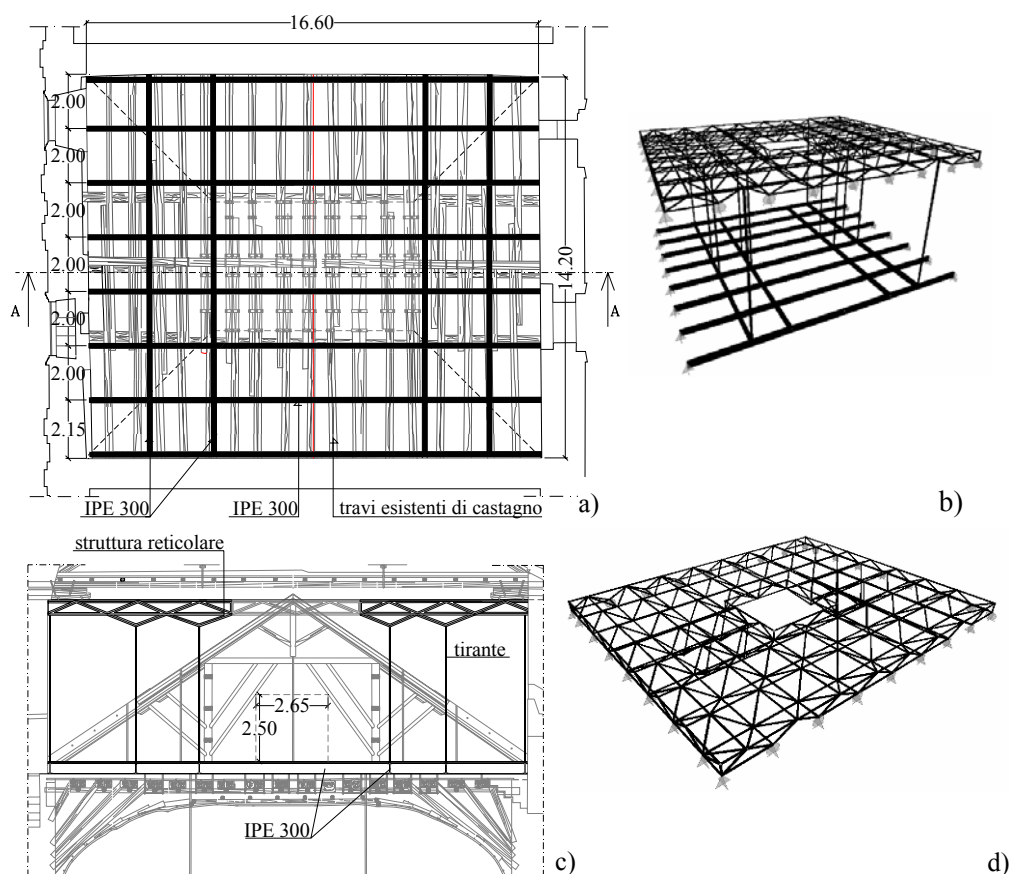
a) Carpenteria solaio; b) Vista 3D dell'intera struttura; c) Sezione A-A; d) Vista 3D della struttura reticolare.
